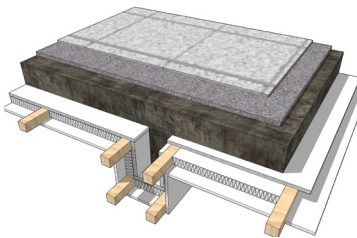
Losa hormigón armada espesor 150 mm. con sobrelosa y pavimento cerámico. Bajo losa, aislación en base a poliestireno expandido en dos capas con estructura secundaria de apoyo para terminación inferior en placa de yeso cartón de 15 mm. de espesor
